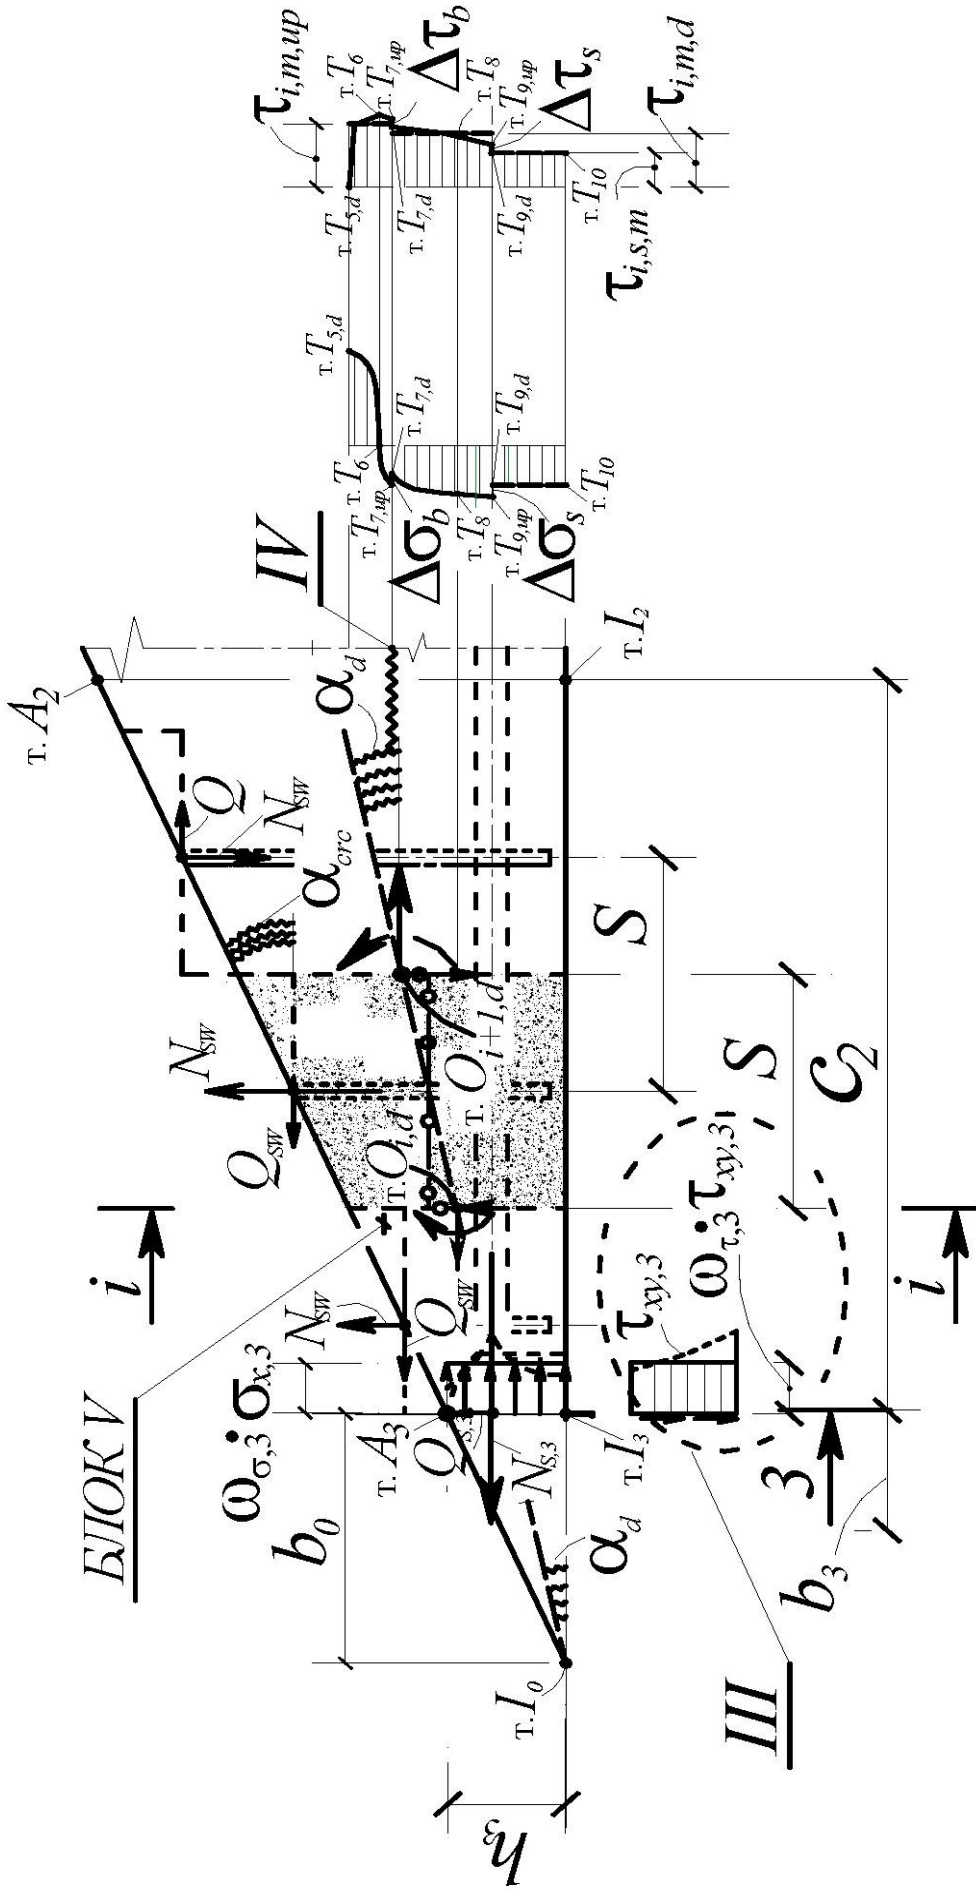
Расчетная схема к определению напряженно-деформированного состояния в i -ом поперечном сечении V блока железобетонной составной конструкции
